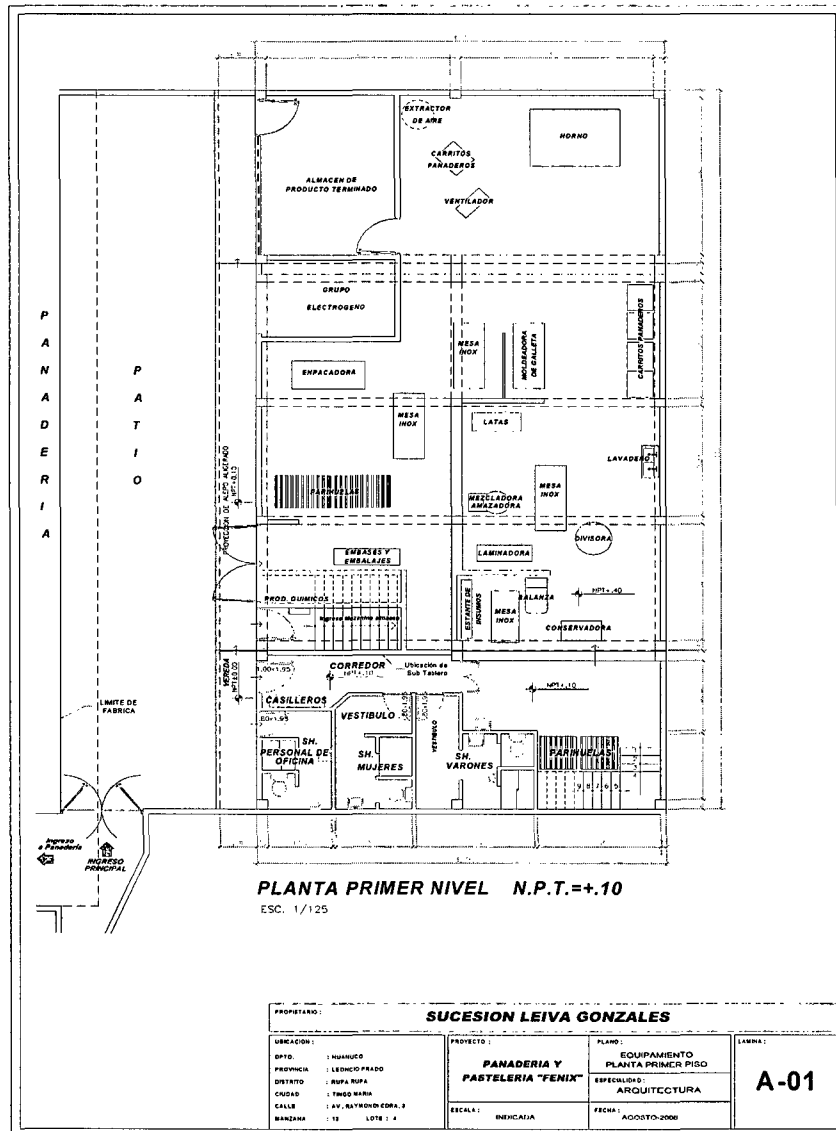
Diseño de planta del primer nivel (Ubicación de máquinas y equipos).
